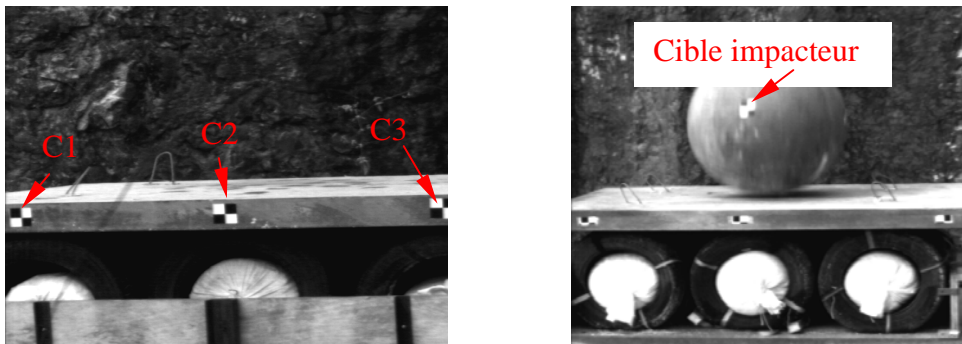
essai avec coffrage dans la longueur de la dalle, essai sans coffrage dans la longueur
